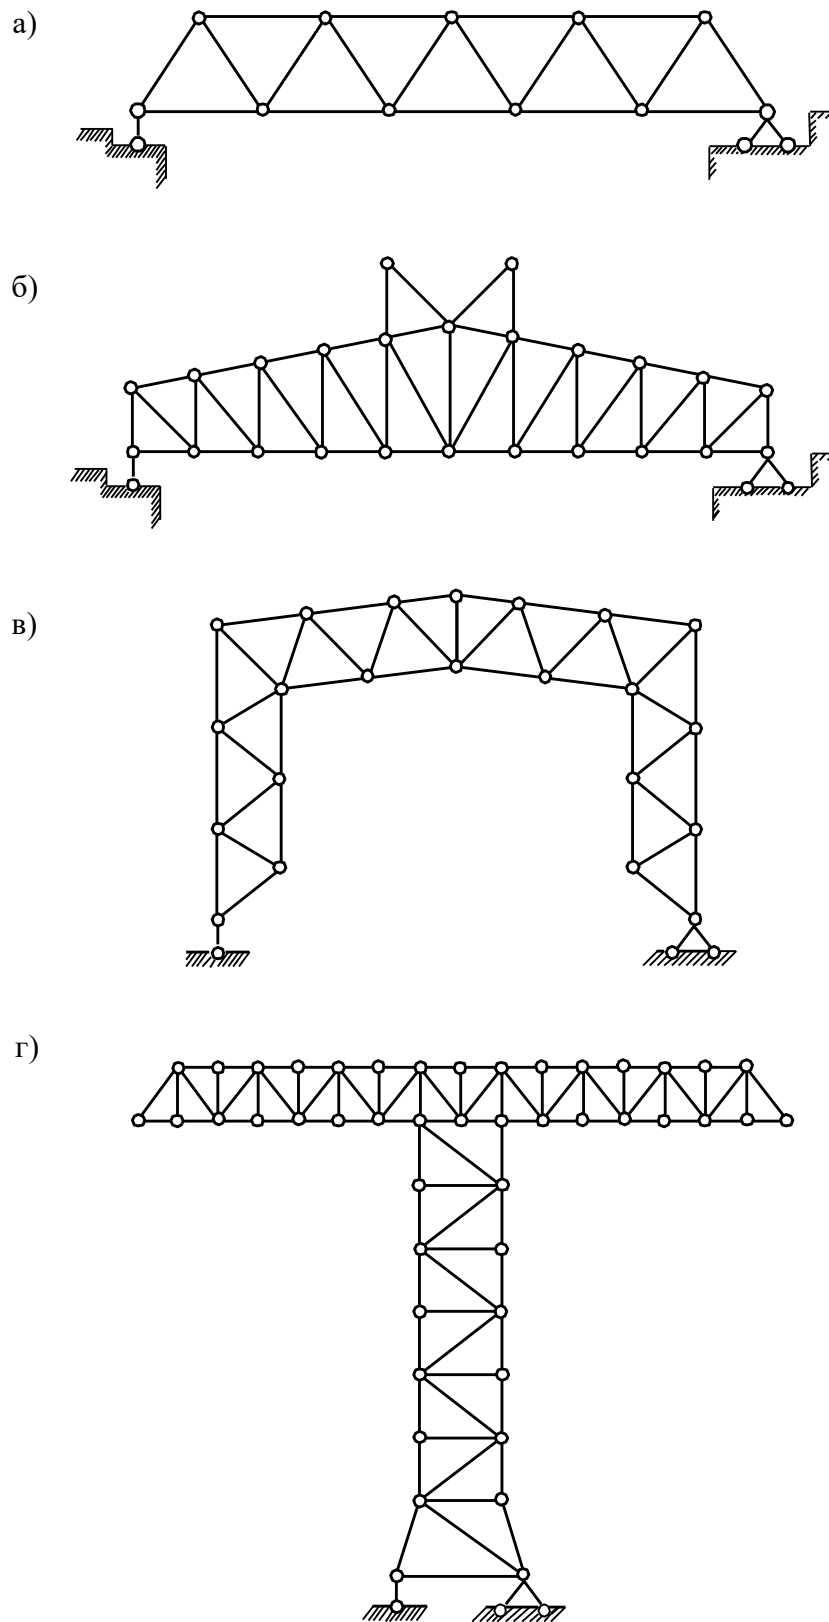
Типи ферм залежно від призначення: а – ферма прогонової будівлі моста; б – кроквяна ферма з надбудовою для ліхтаря; в – ферма каркаса промислового цеху; г – ферма підйомного крана
